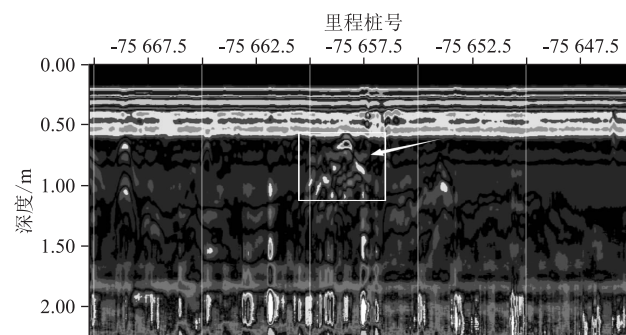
混凝土内不密实缺陷的雷达剖面图
